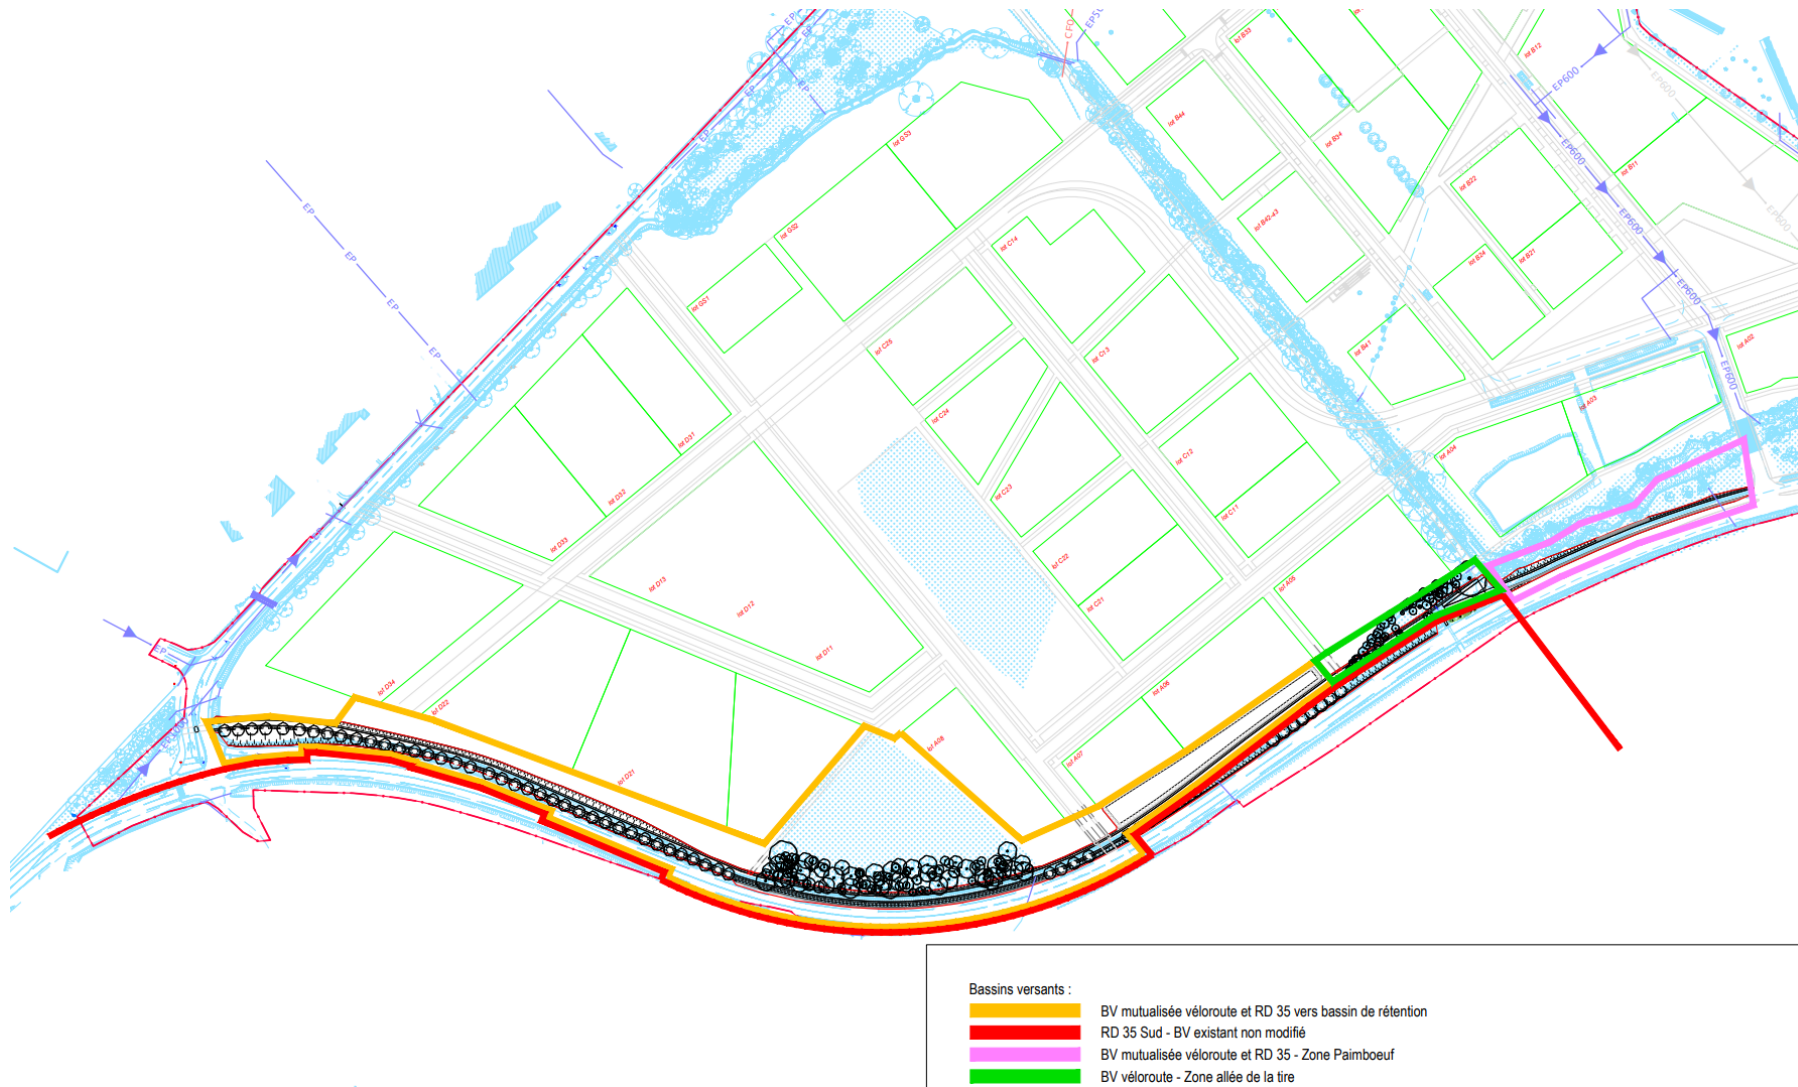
Plan des sous bassins versants hydrauliques de la véloroute sur Très-la-Grange, dossier PRO véloroute TLG, ALTO STEP, juin 2021
